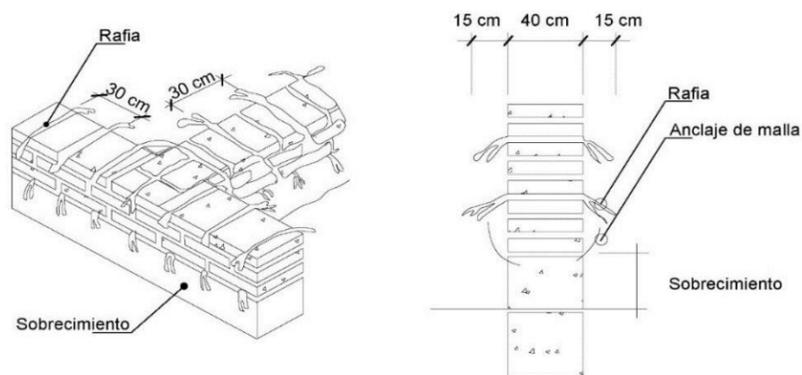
Colocación de rafia para refuerzo de malla. Fuente: equipo de trabajo
